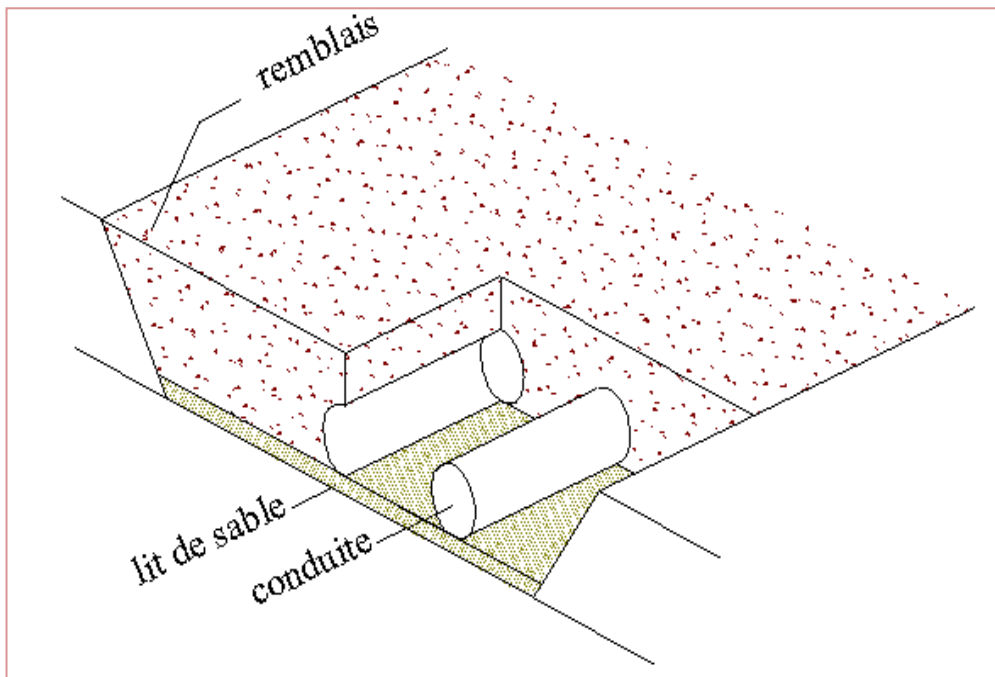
Coupe transversale d'une tranchée avec la mise en place de la conduite
